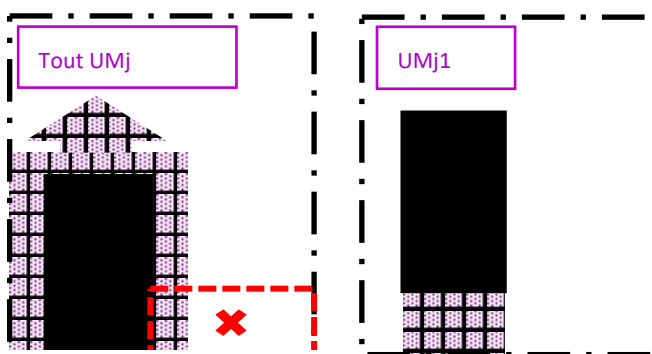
zones d'implantation possibles et interdites pour les extensions de la construction
